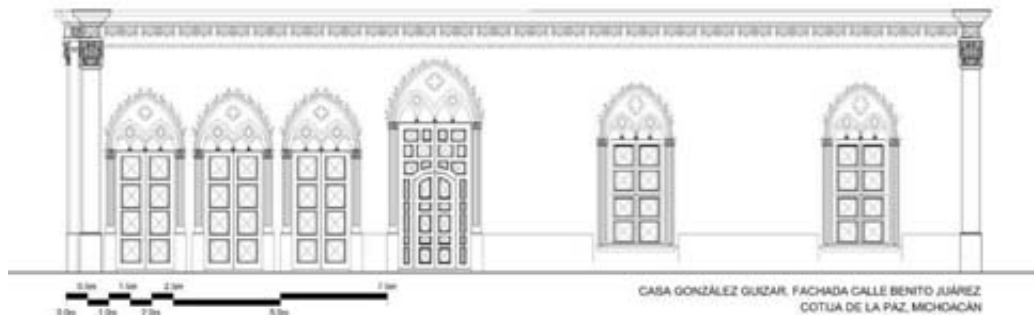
Posible reconstrucción de la fachada sur de la casa González Guízar con sus aplanados
